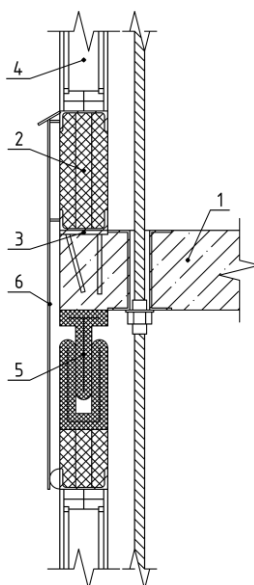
Узел крепления наружных стен к плите перекрытия: 1 – плита перекрытия; 2 – стеновая панель; 3 – закладная деталь; 4 – оконный блок; 5 – гибкая прокладка; 6 – навесной фасад
